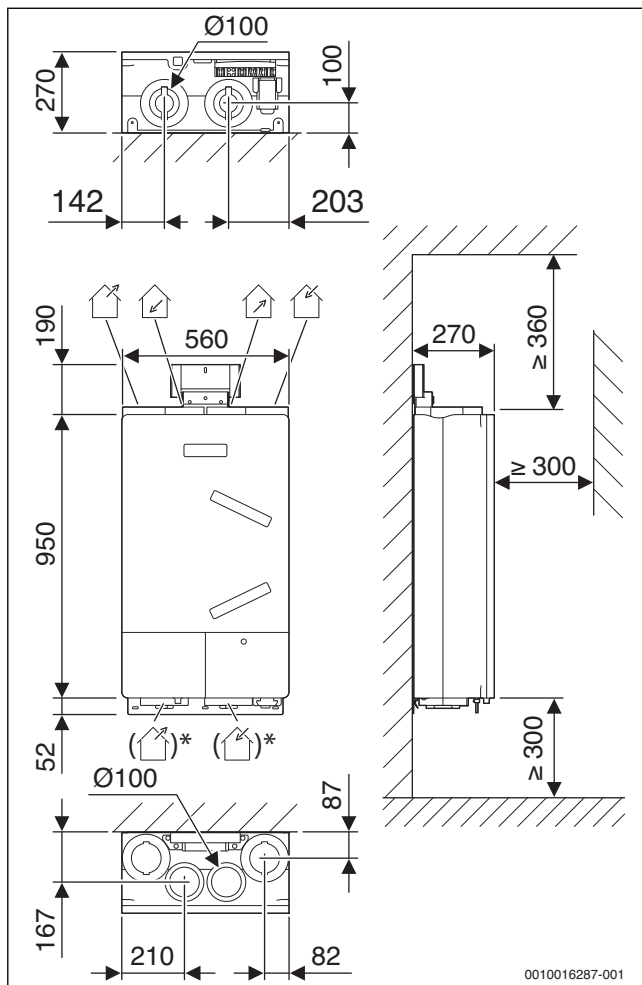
Abmessungen und Mindestabstände Wandinstallation Logavent
